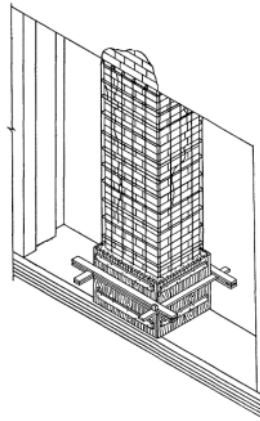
Установка опалубки при усилении простенка железобетонной облоймой
